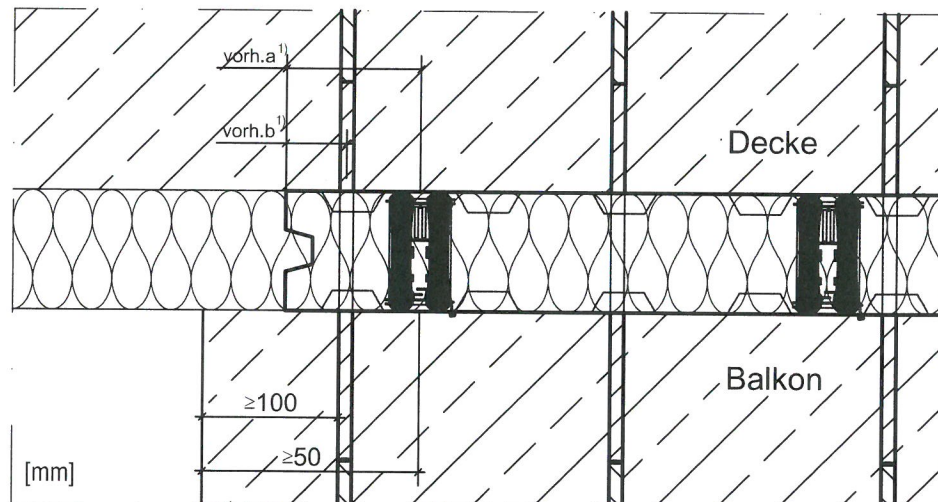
Rand- und Dehnfugenabstände [mm] der Querkraftstäbe und Betondrucklager (Schöck Isokorb Typ QXT und QXT-IK6)
